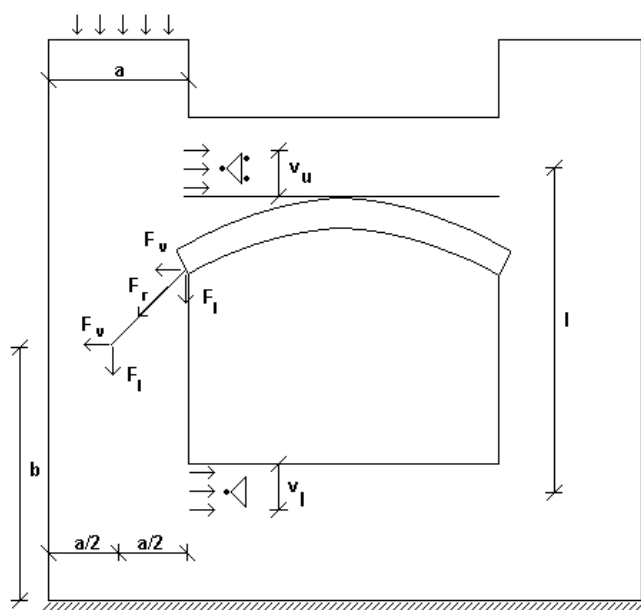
Buekonstruktion ved enden af en facade
